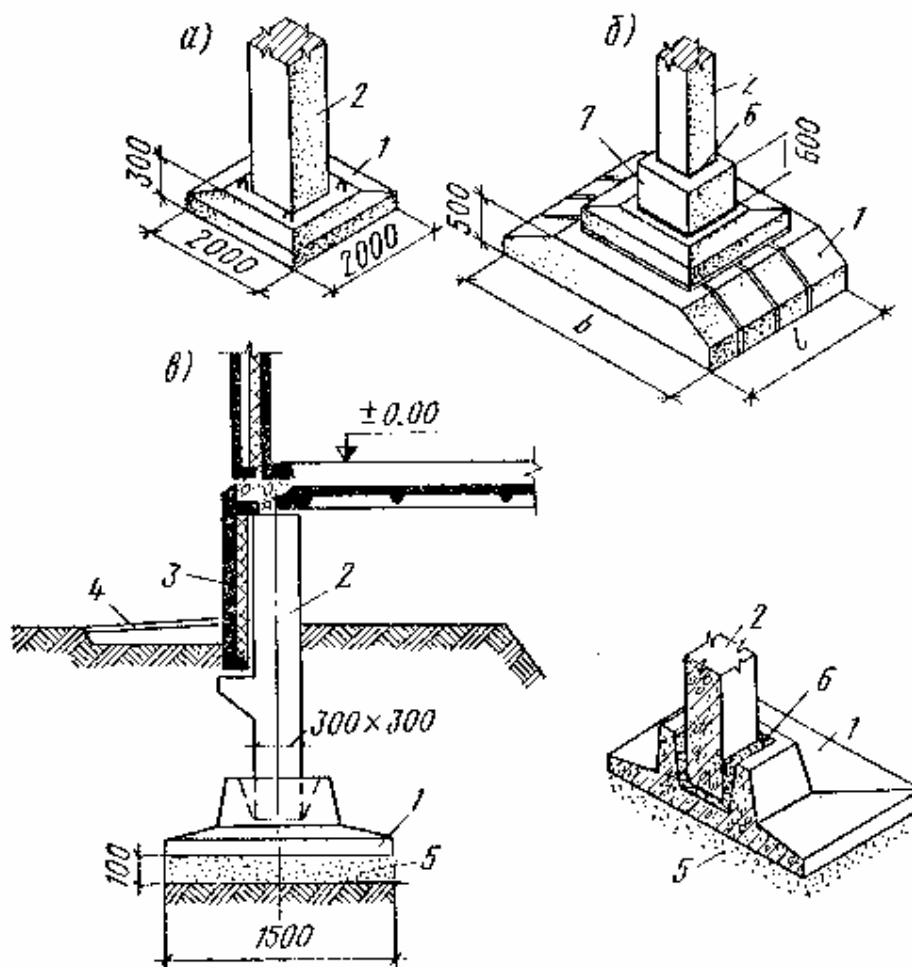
Сборные столбчатые фундаменты многоэтажных зданий:
